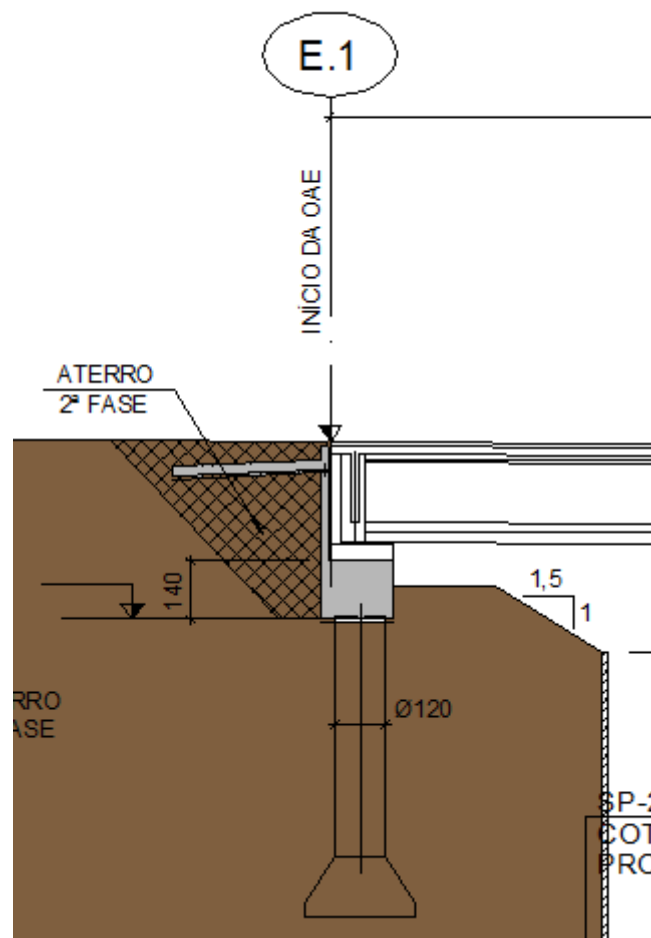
Elevação típica de um encontro com fundação por tubulões
